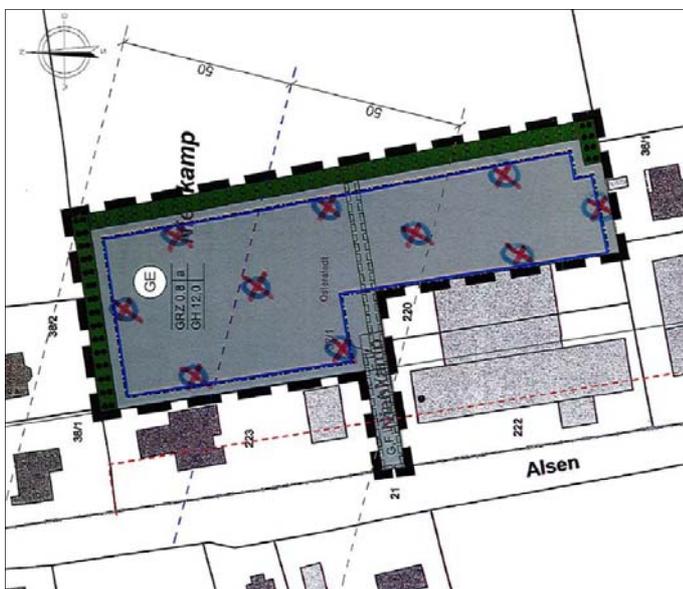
Lageplan Anl. 1.1 (o. M.)
